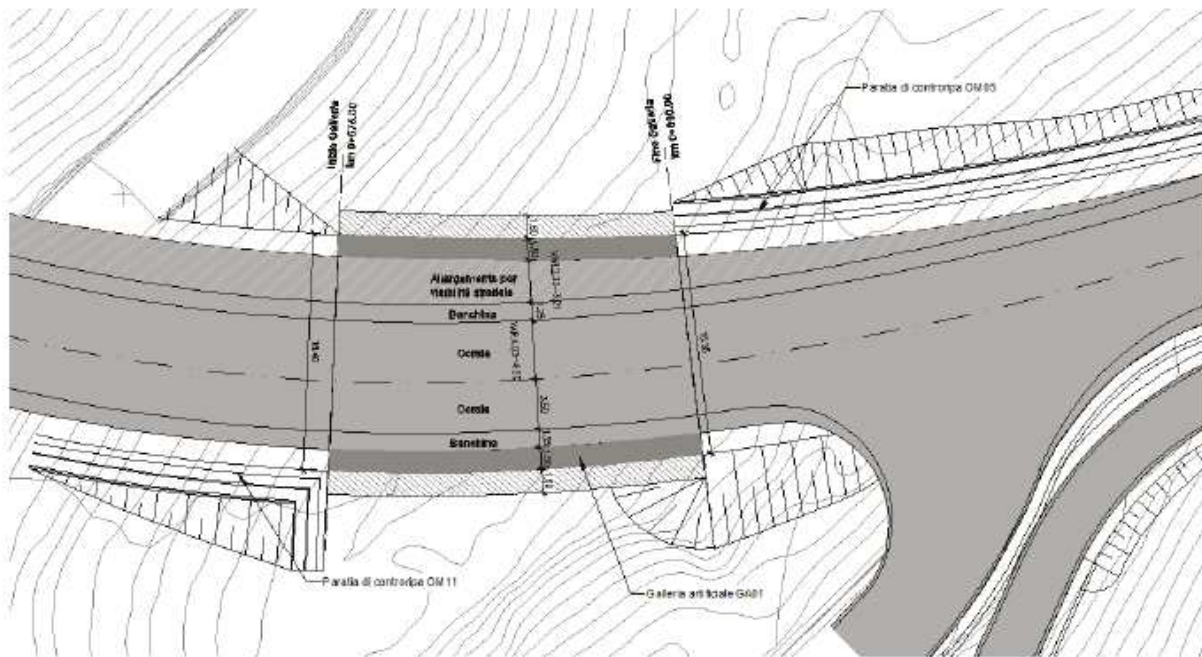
Galleria artificiale – Planimetria e sezione longitudinale
